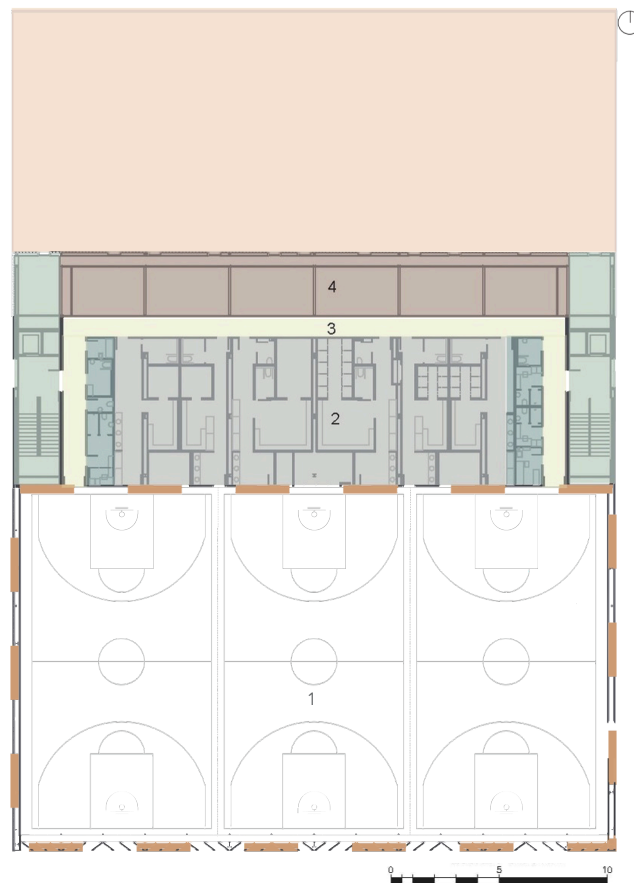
Planta subsuelo polideportivo Camp Ferro
